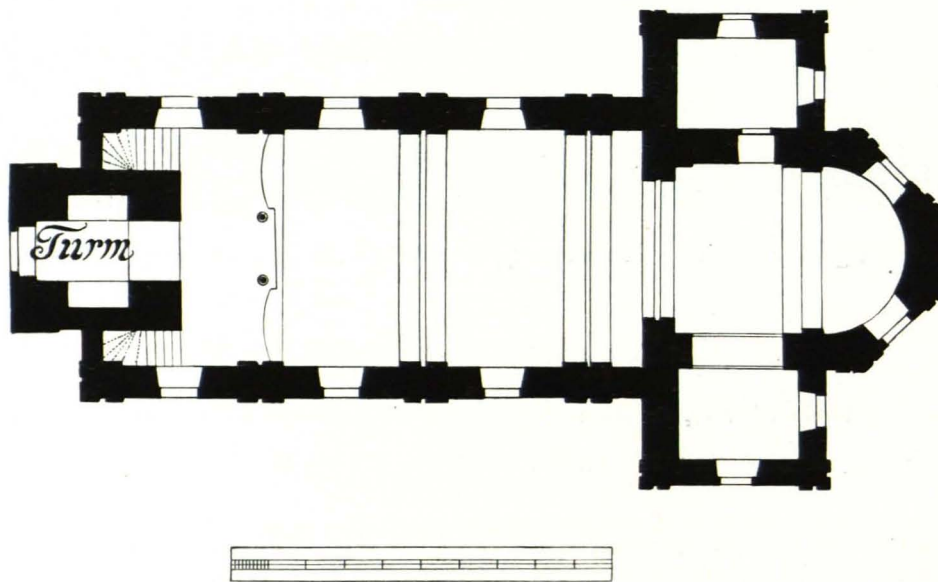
Gutenbrunn, Pfarrkirche, Grundriß 1:200 (S. 42)
